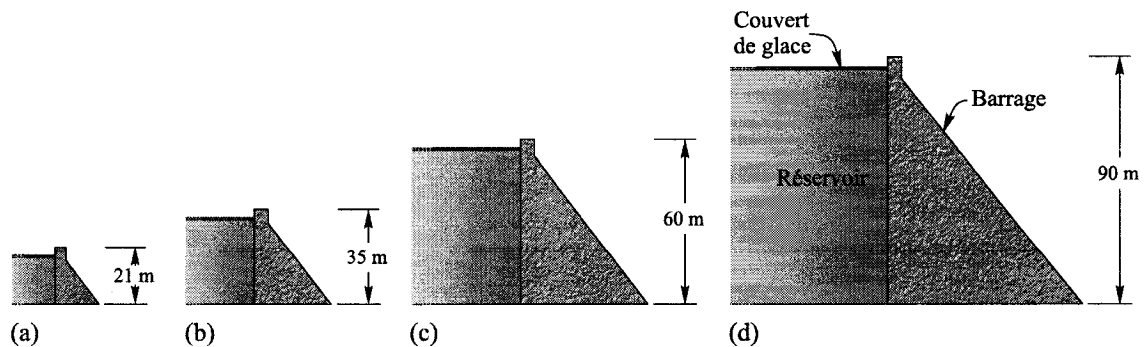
Système glace-barrage-réservoir à l'étude : (a) barrage 21 m d'hauteur; (b) barrage 35 m d'hauteur; (c) barrage 60 m d'hauteur; (d) barrage 90 m d'hauteur.
